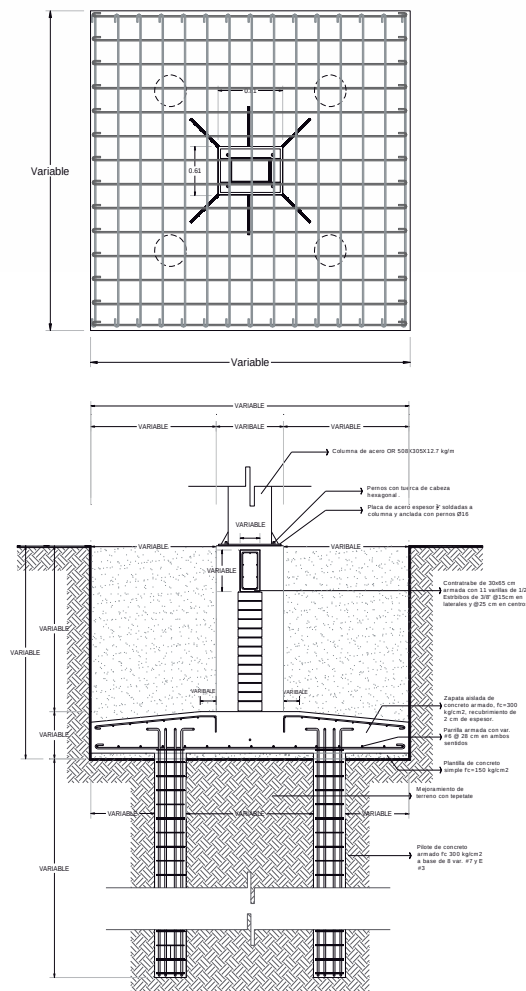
Detalle de zapata corrida con pilotes en planta y alzado. Elaboración propia.
